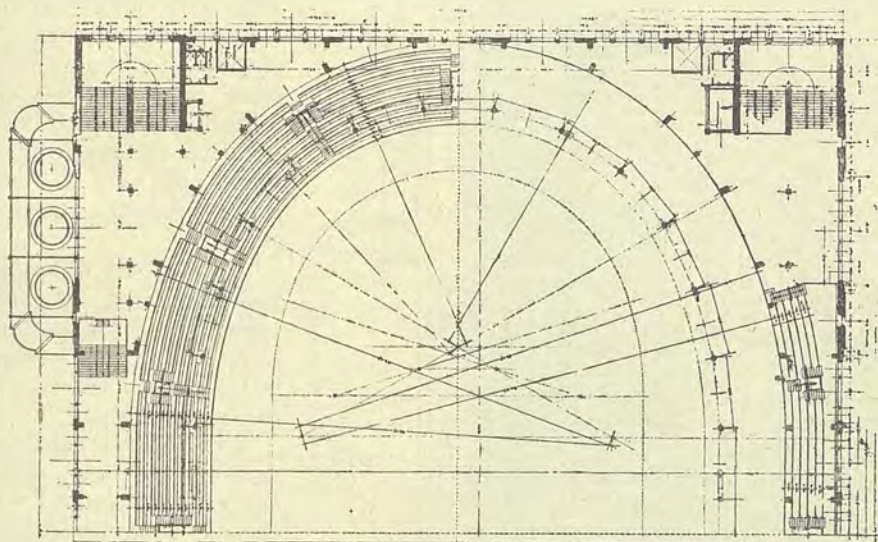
b. — Pianta del 1° e 2° piano colle tribune.
